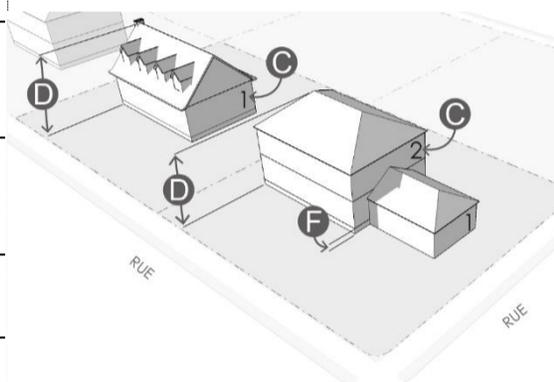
Hauteur d'un bâtiment et du plancher du rez-de-chaussée
